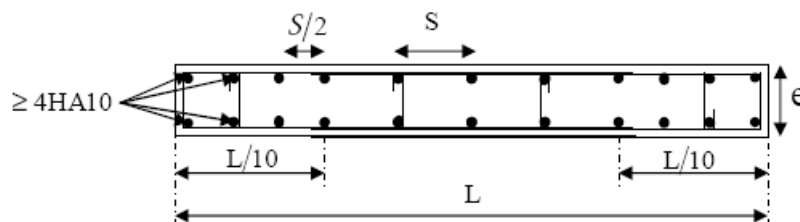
Disposition des armatures verticales dans les voiles.
